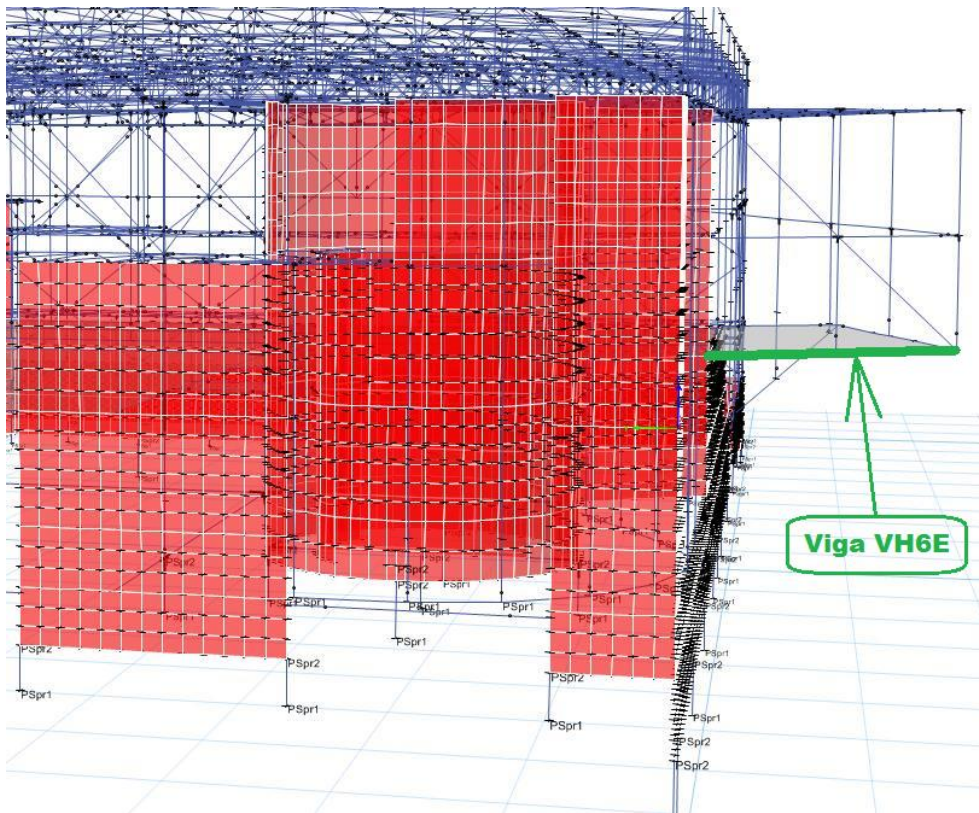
Vista del costado del Auditorio del modelo de Etabs, donde se puede apreciar el sector en voladizo que soporta (en parte) la viga VH6E.
